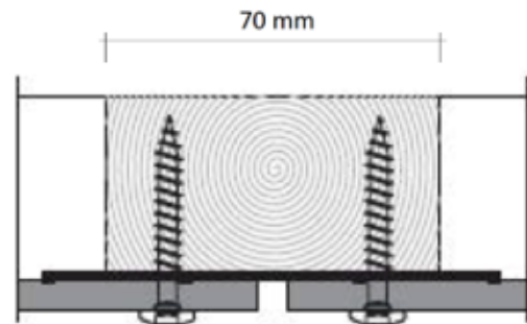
Coupe verticale sur joint horizontal (joint ouvert)
